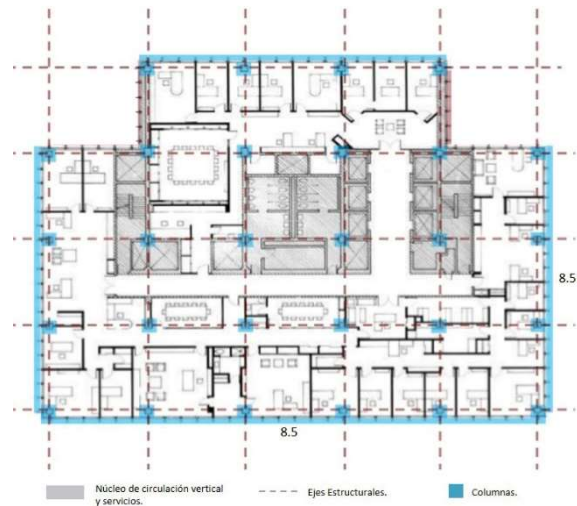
Estudio de estructura y circulación vertical. Edificio Seagram.
